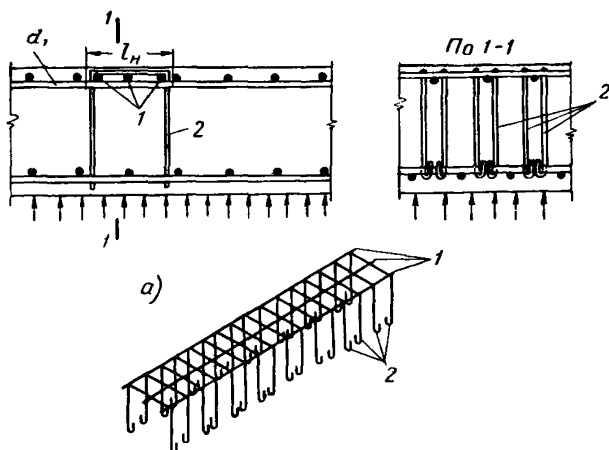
Дополнительные сварные хомуты, укладываемые в местах стыков основных сварных сеток (нагрузка приложена снизу, верхняя арматура растянута)
